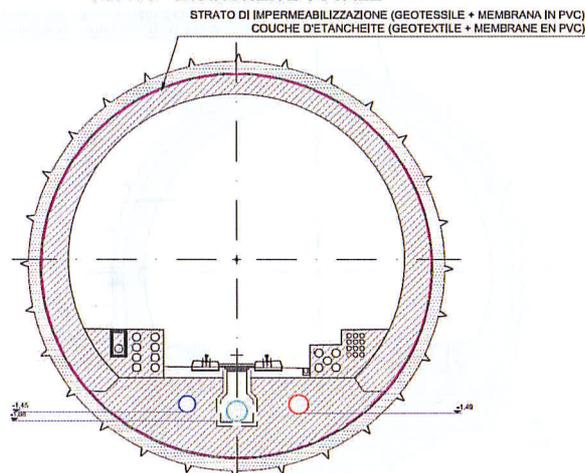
Impermeabilizzazione di tipo 3 per scavo con TBM aperta
